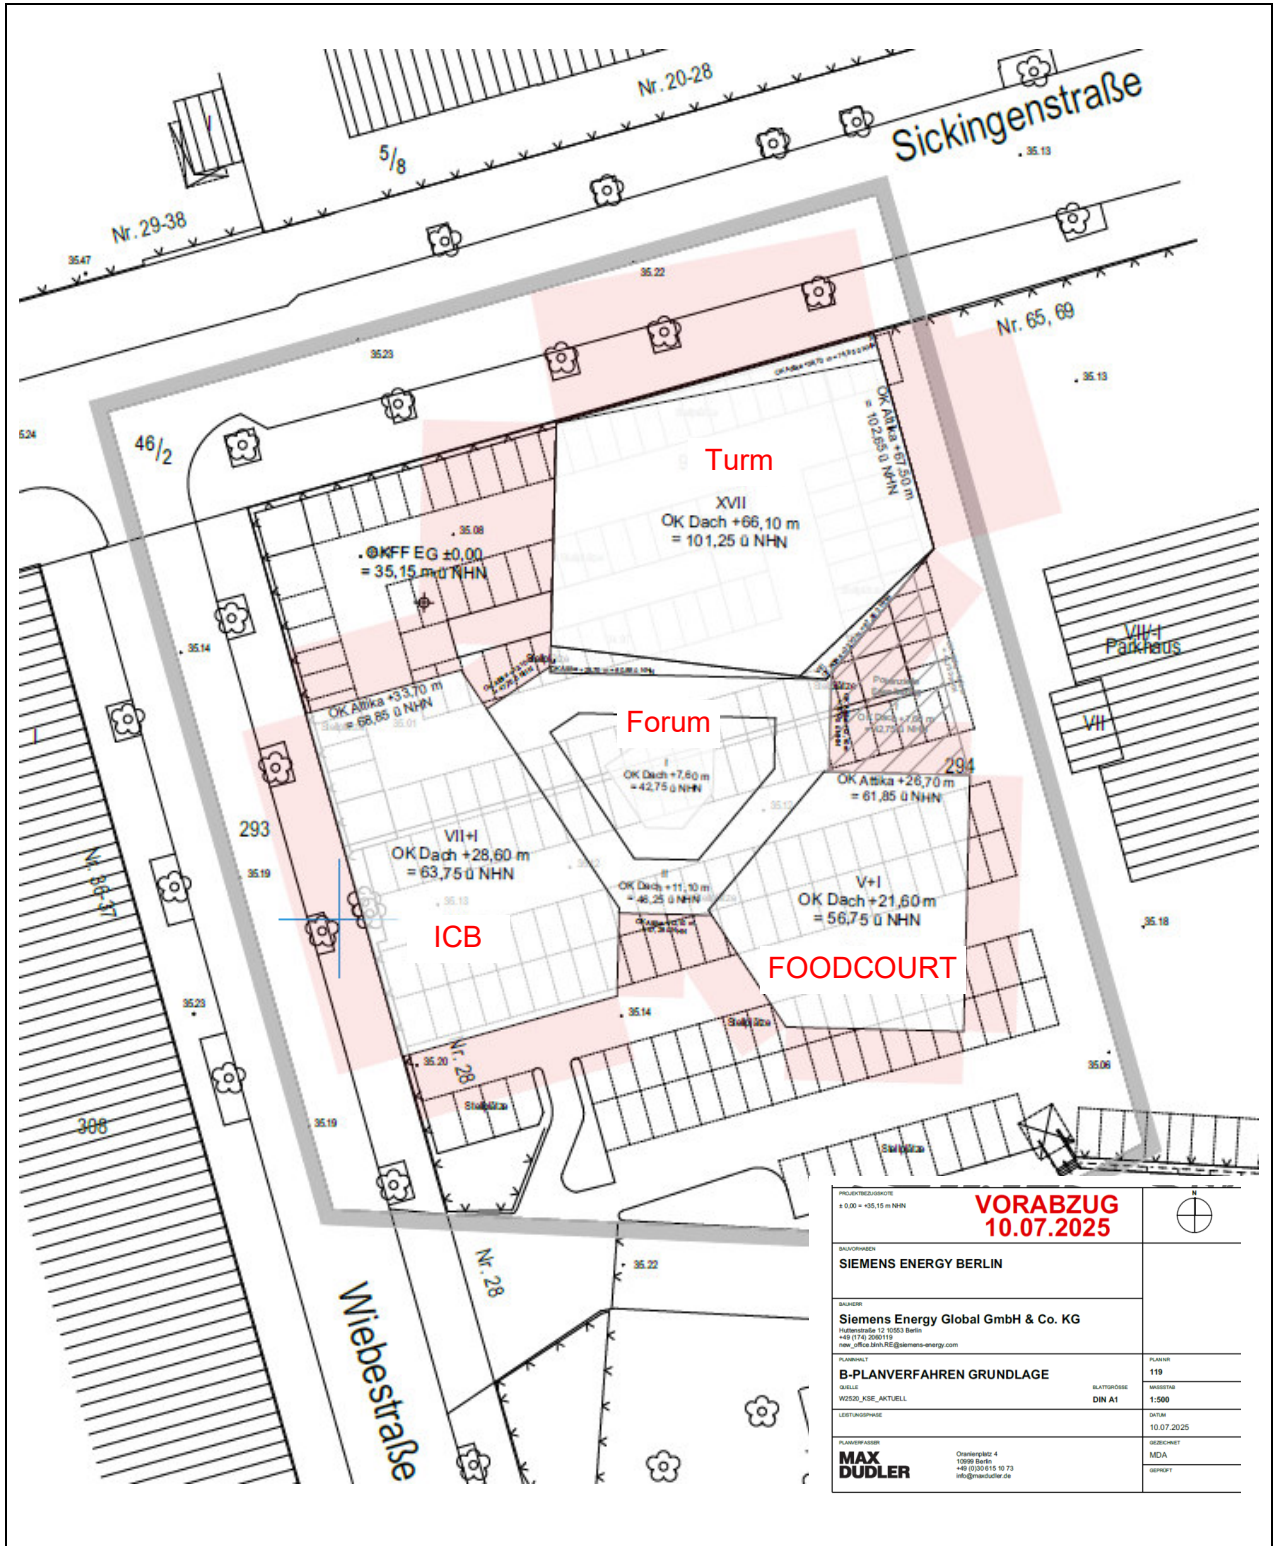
Bauvorhaben, Aufsicht, Grundrisse, Höhen
